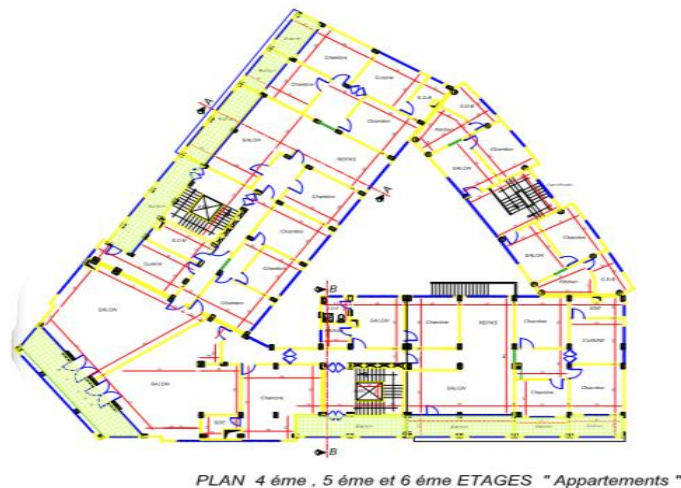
Plan des niveaux 4,5 et 6 de l'immeuble échantillon
